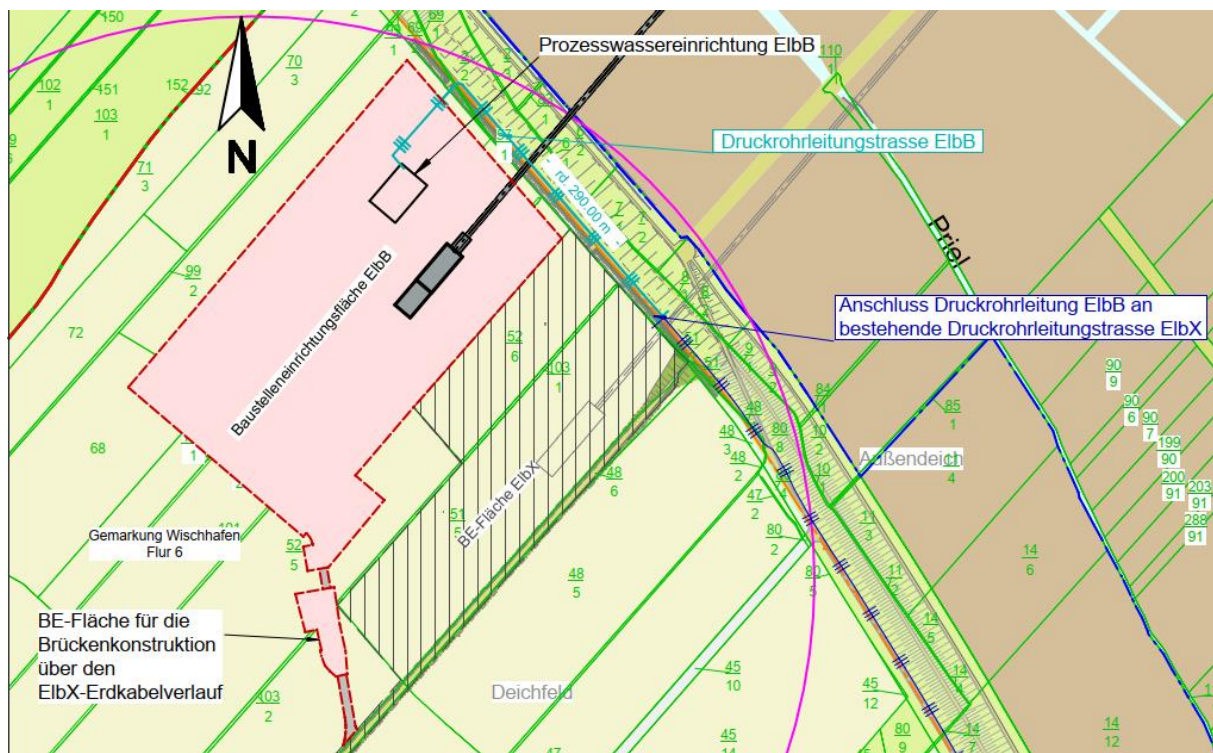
Planausschnitt – Anschluss Druckrohrleitung ElbB an bestehende Druckrohrleitungstrasse ElbX in NI (vgl. Anhang Teil F5.9, Lageplan Prozesswasser NI)
